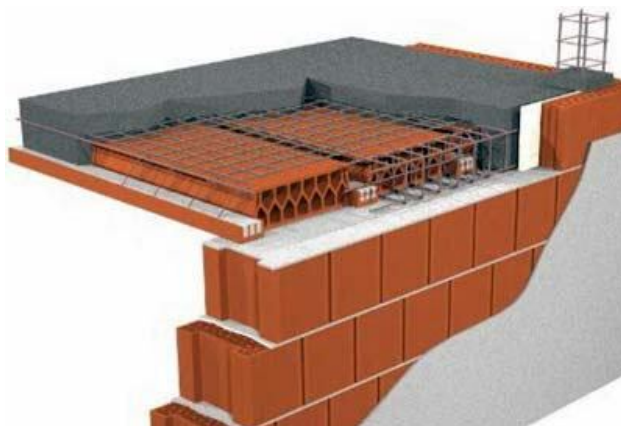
Схема раскладки элементов несъемной опалубки Porotherm
